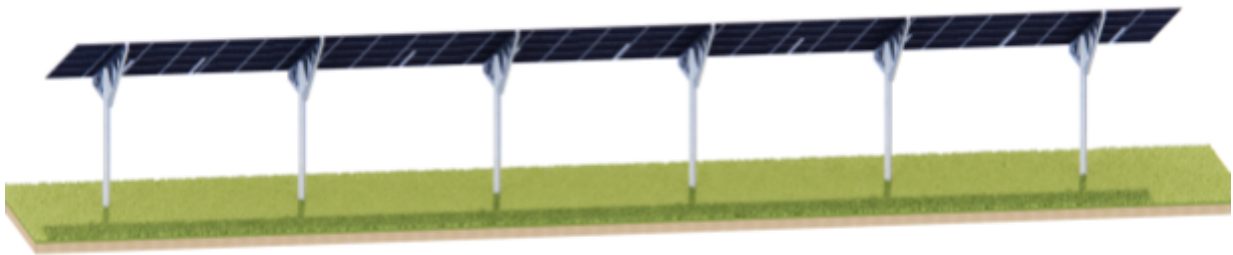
Tipos de estructuras fijas al suelo. Fuente: Elaboración propia.
